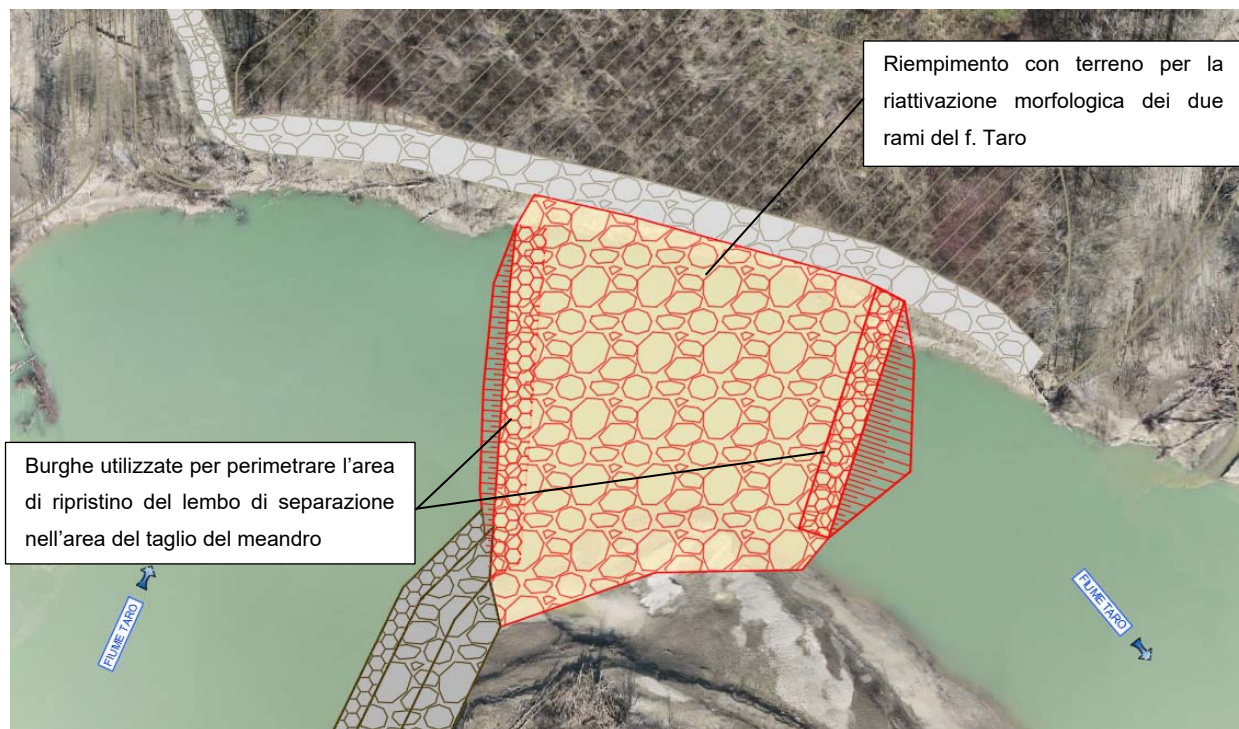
Estratto Tav.PFTE.14 – Planimetria Opera 3
